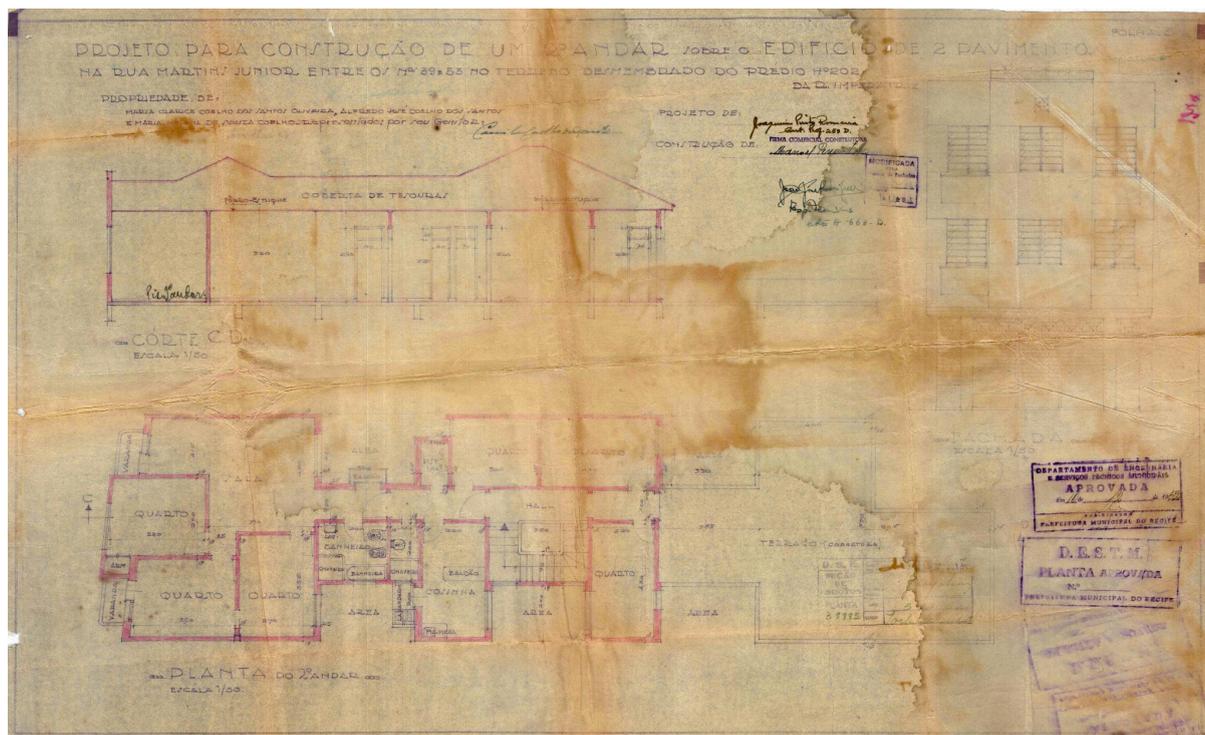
Planta baixa do segundo pavimento, com um apartamento voltado para a Martins Júnior e área de terraço nos fundos. No canto superior à direita, desenho da fachada com três pavimentos
